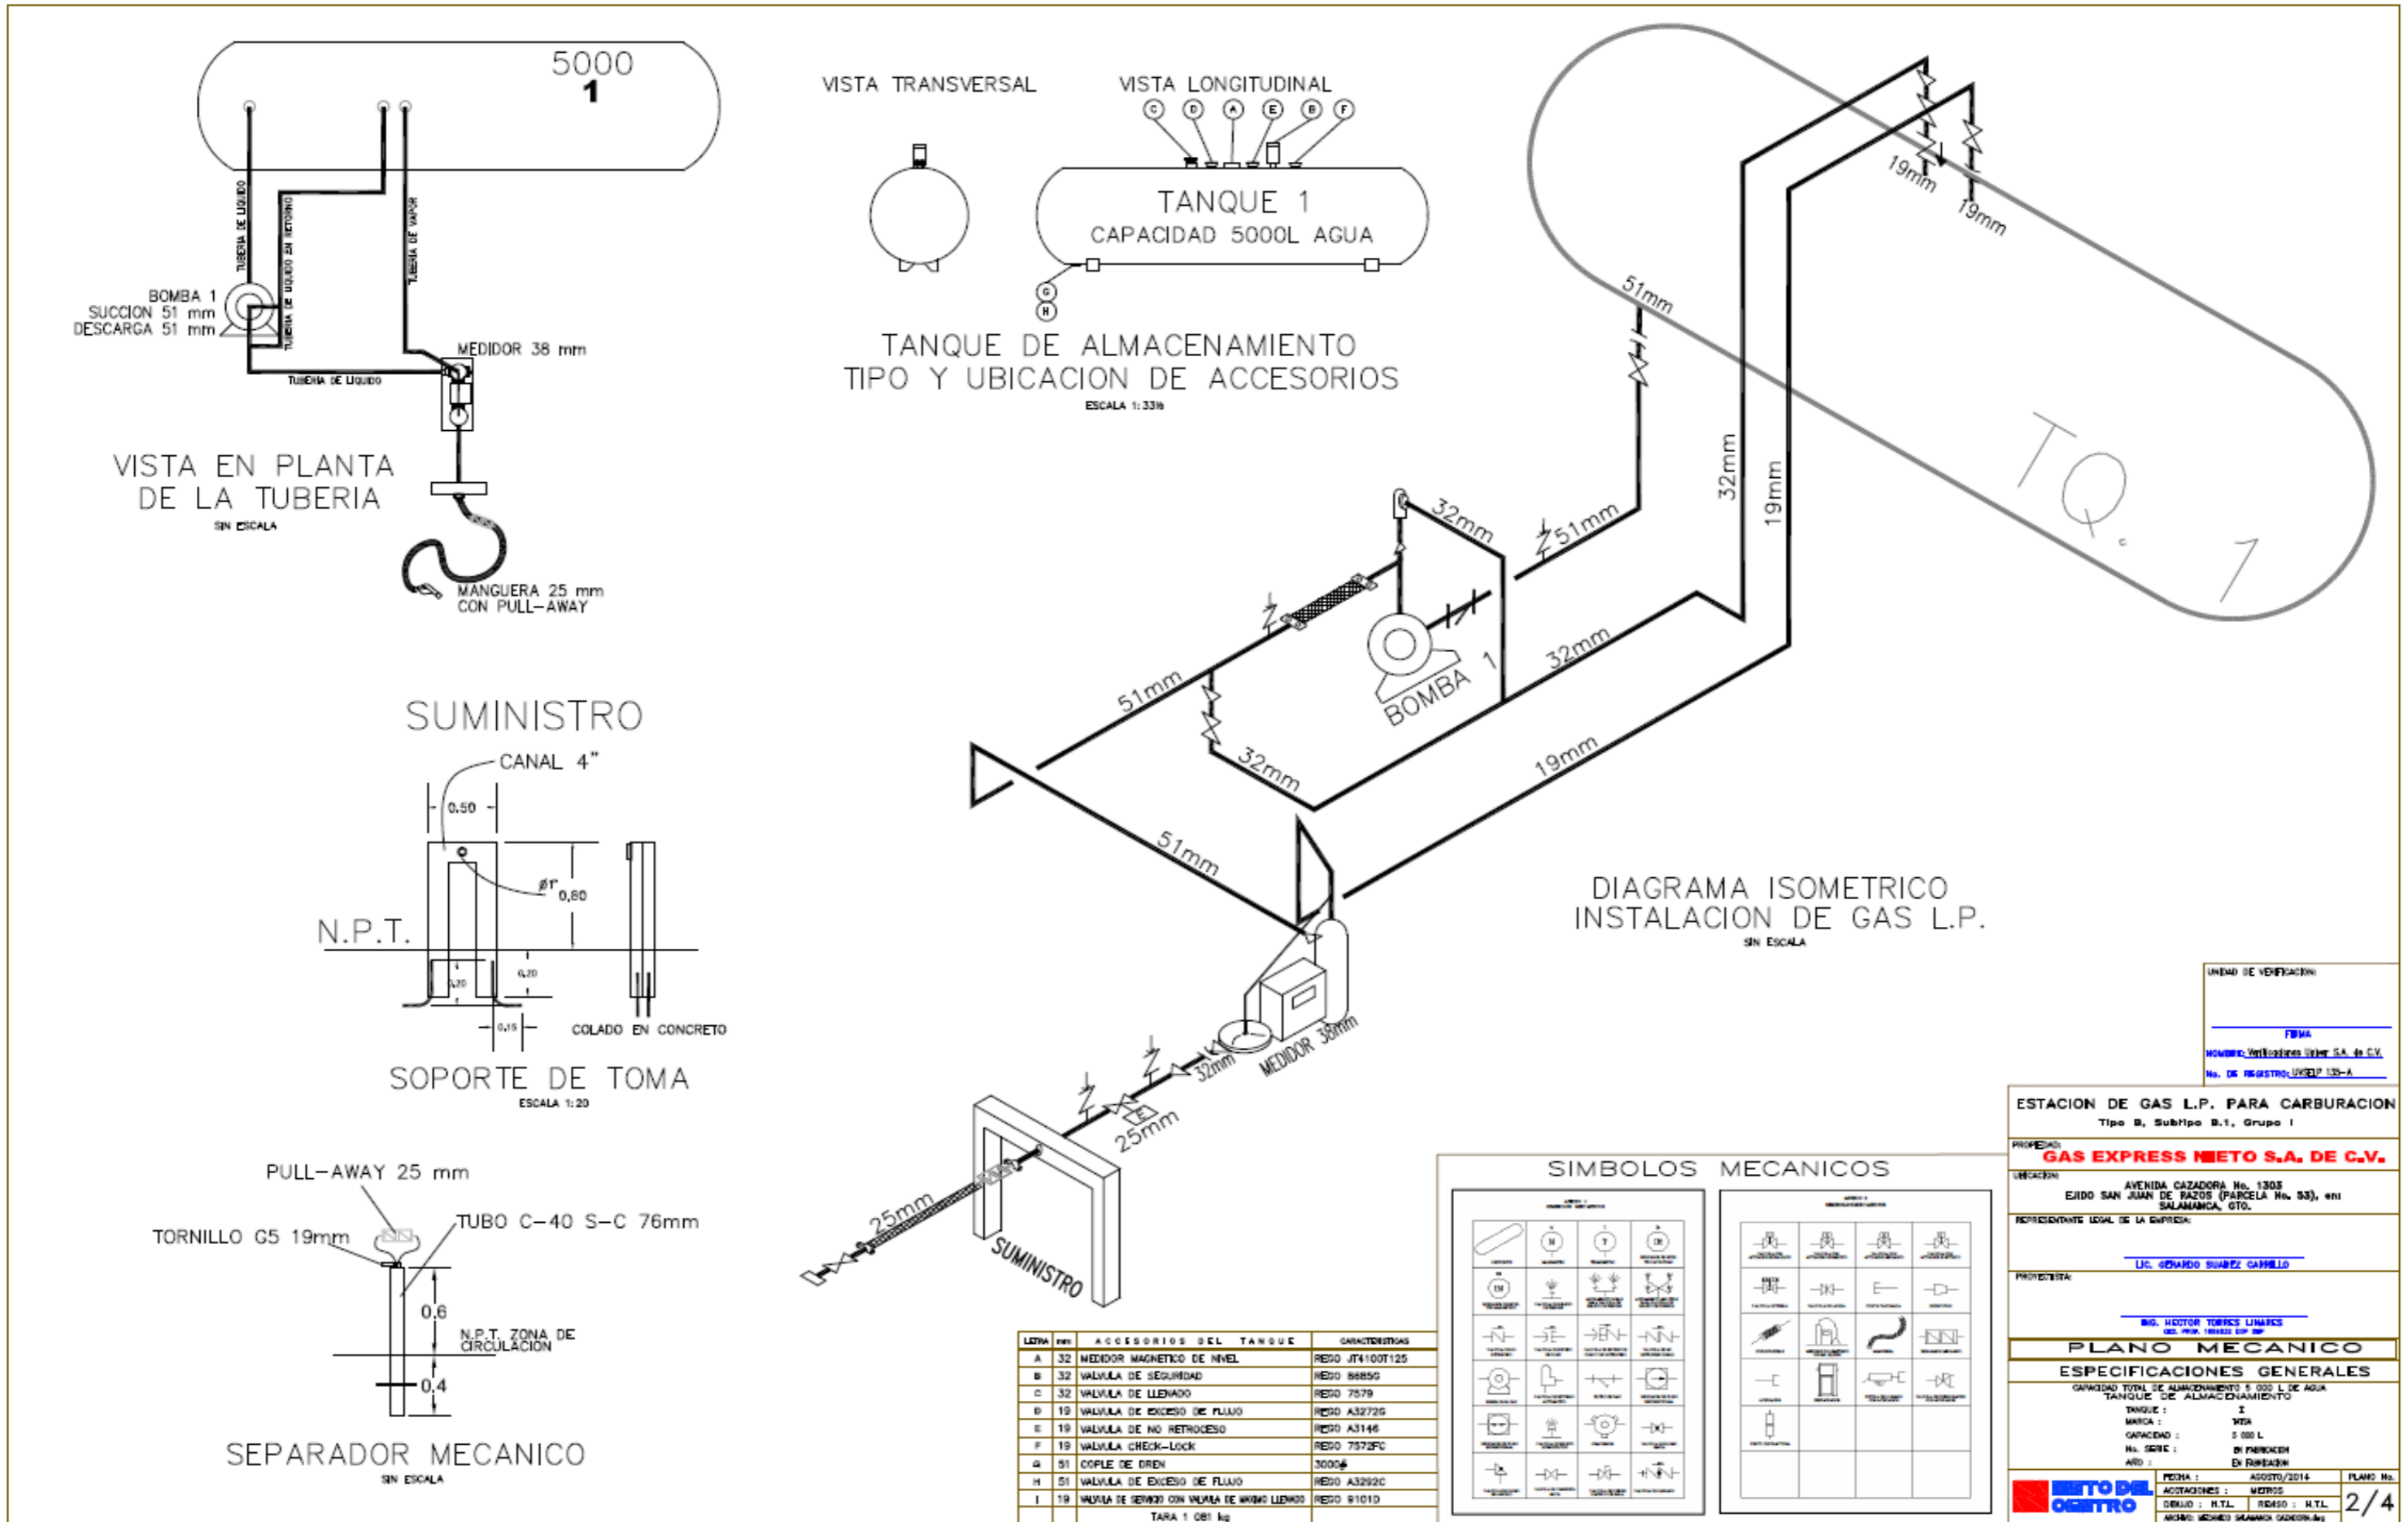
Plano mecánico sin escala con detalles de las construcciones y áreas de la estación proyectada.
